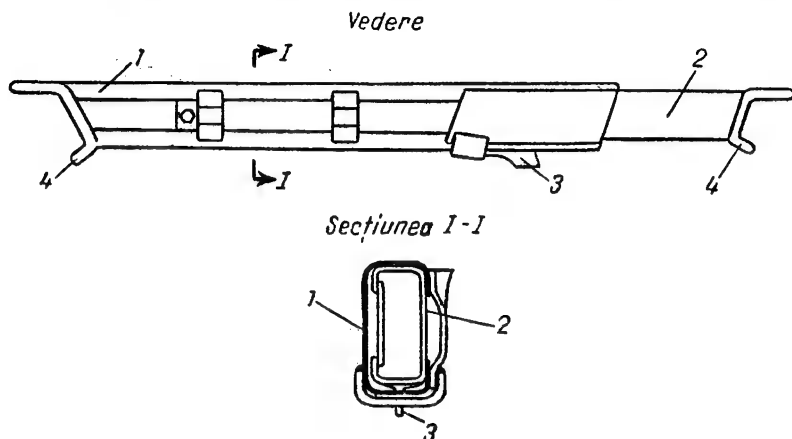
Grindă extensibilă de 1,80—3,00 m :
